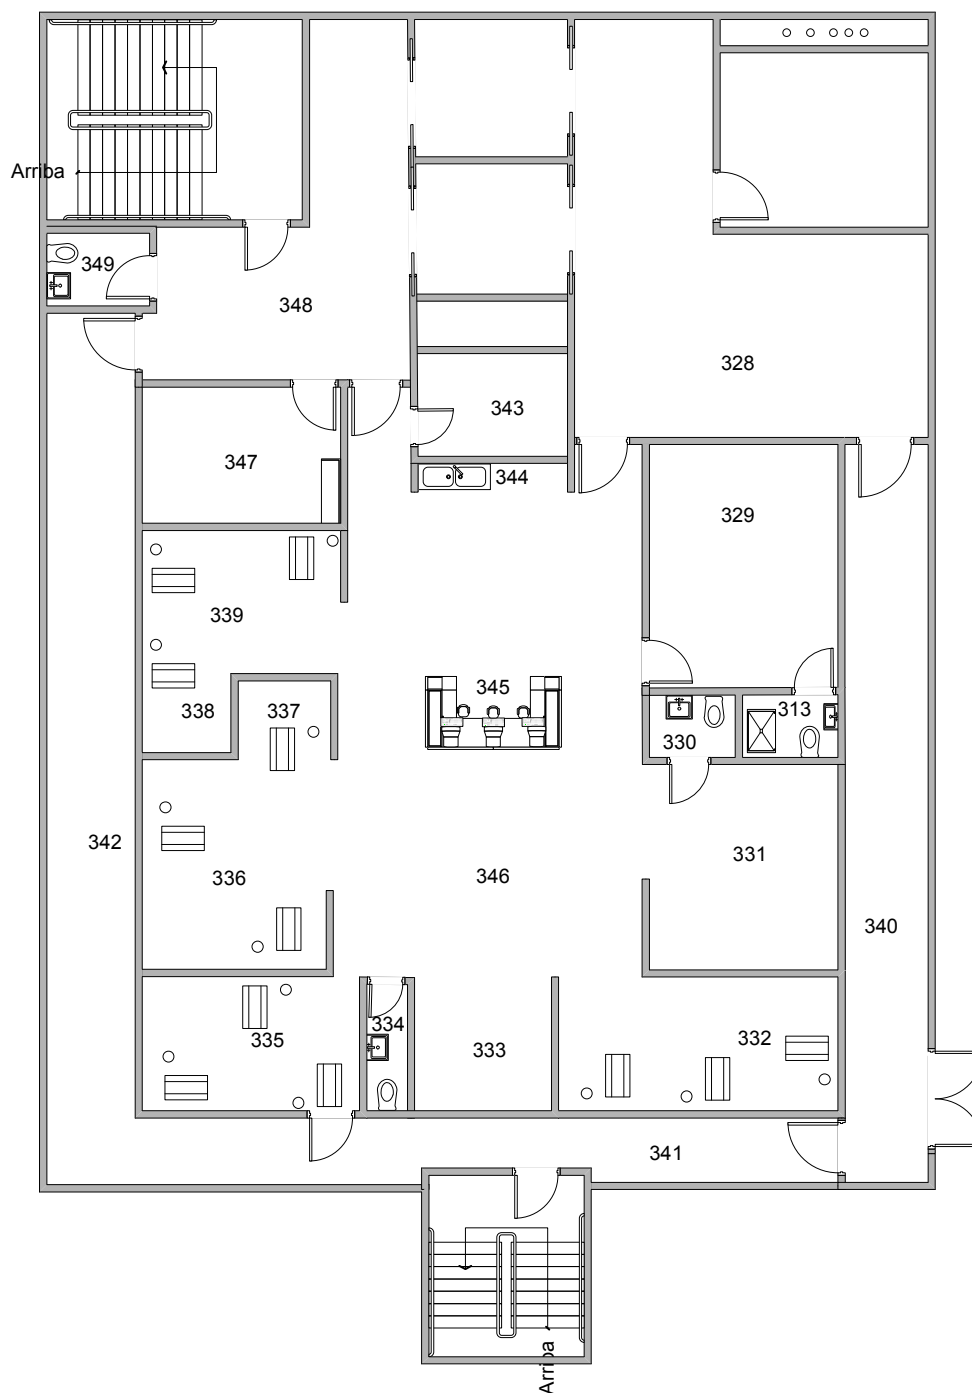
Plano Arquitectónico UCIN¹¹⁸.
